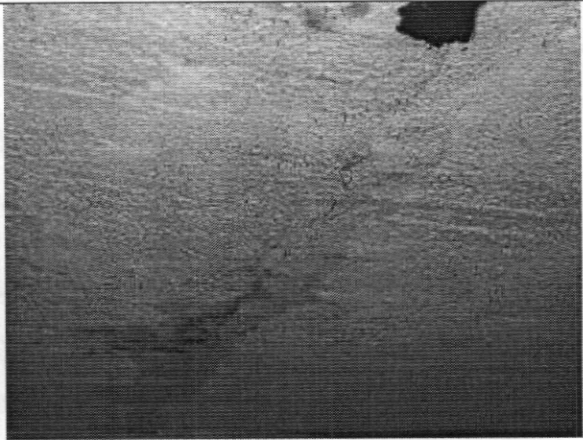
Grieta en placa de entrepiso plataforma.
